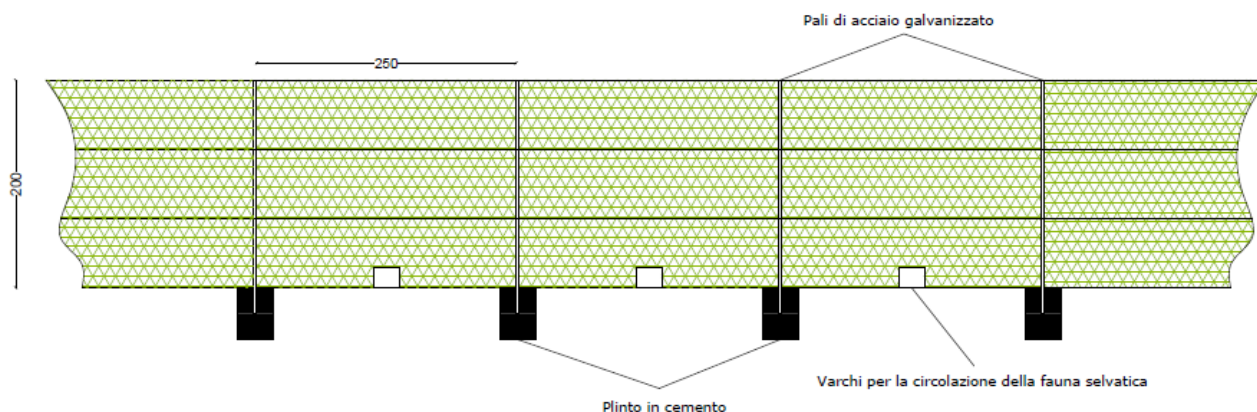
Schema struttura recinzione perimetrale. Da: EP07_signed_signed.pdf.
